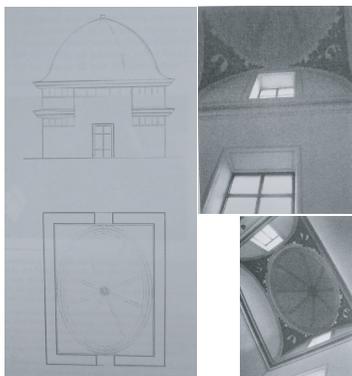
Colegio de los jesuitas de Alicante. Escalera principal: alzado, planta y detalles.
